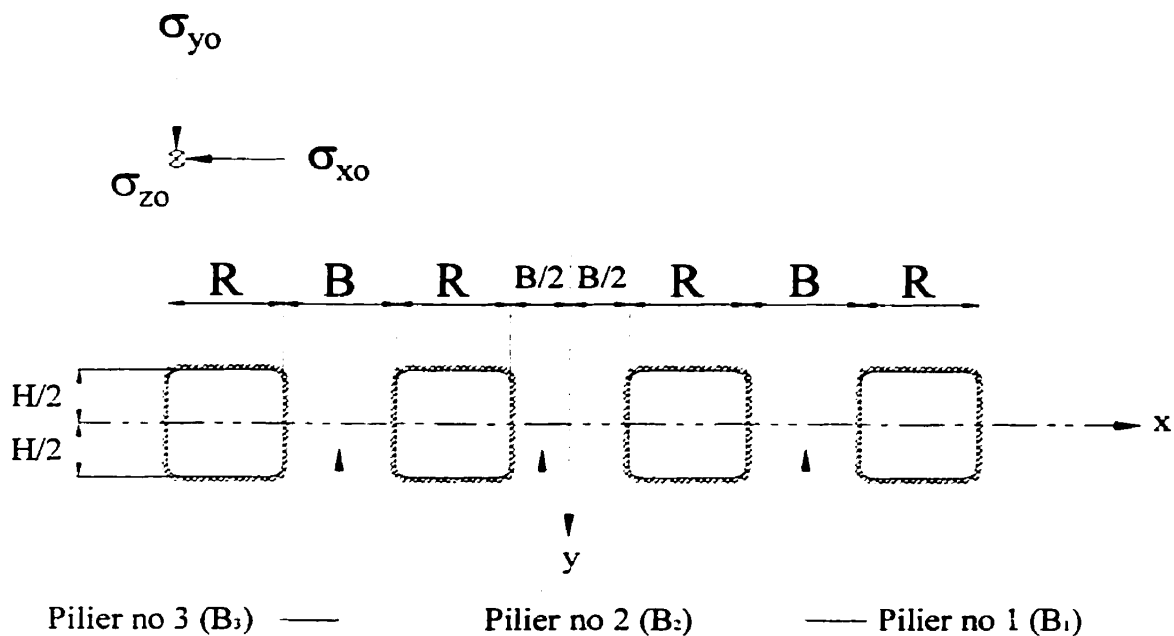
Cas IV, structure minière comprenant trois piliers, section suivant le plan xy, [Gill et al., Designing Mine Pillars with the Convergence-Confinement Method.,1994].
